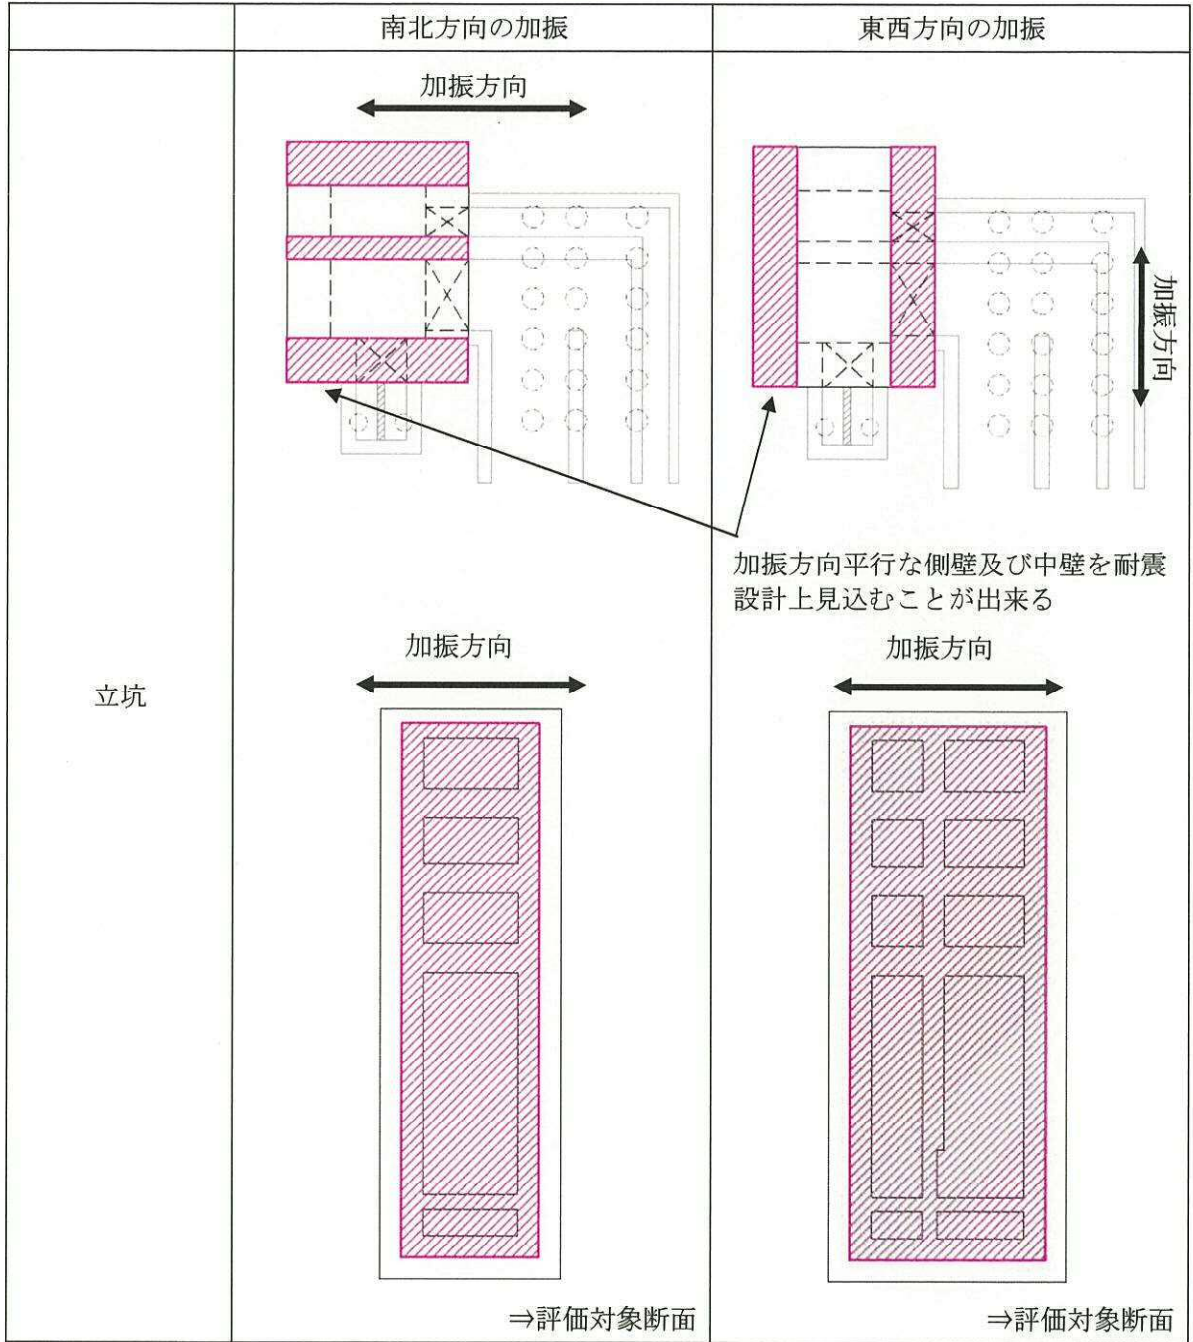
(2) 立坑の平面配置図 (拡大図)
